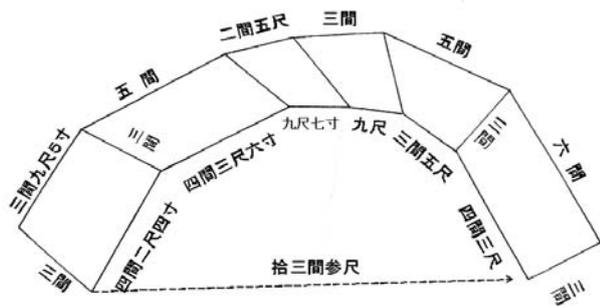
伏木御台場之平面図 (高岡市史編纂委員会, 1963).
